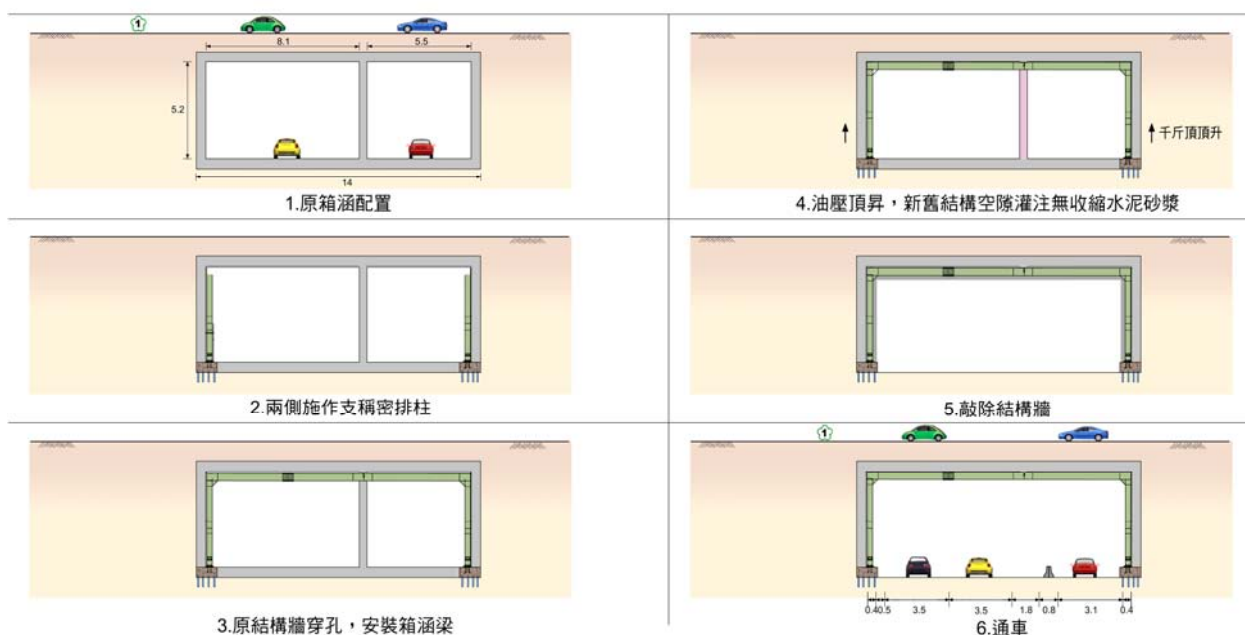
箱涵鋼梁頂昇施工示意圖
